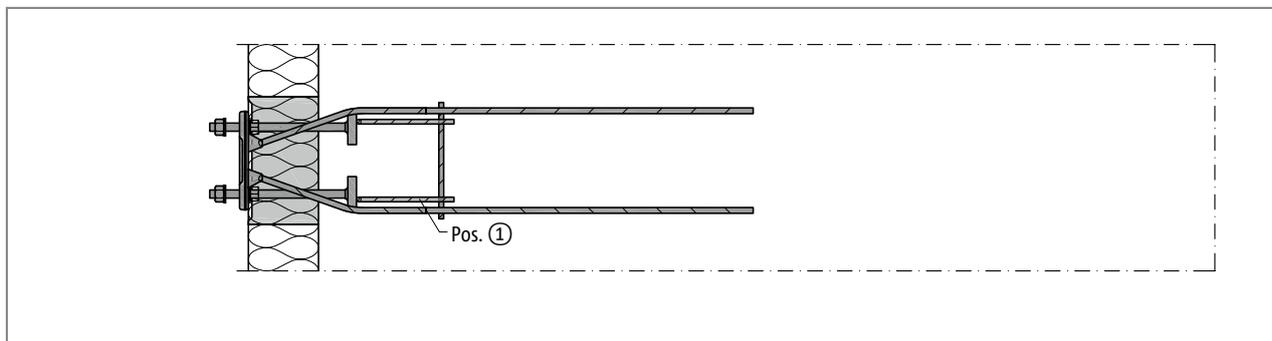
Schöck Isokorb® XT Typ SQ: Bauseitige Bewehrung, Grundriss
